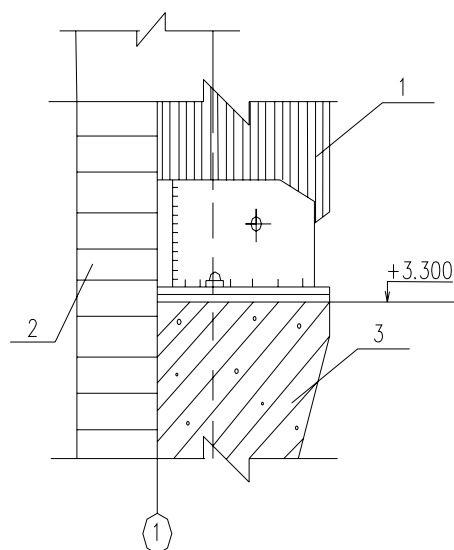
Опорный узел: 1 – клееная деревянная рама, 2 – кирпичная стена, 3 – консоль монолитного ростверка фундамента
